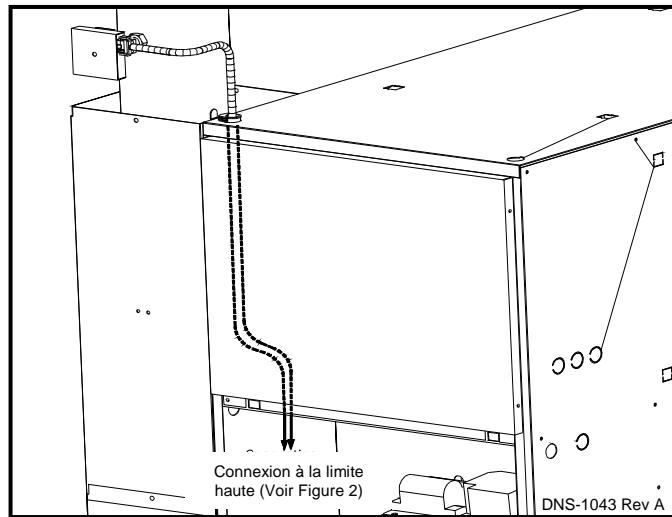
Branchement dispositif anti-refoulement, installation horizontale avec évacuation horizontale
